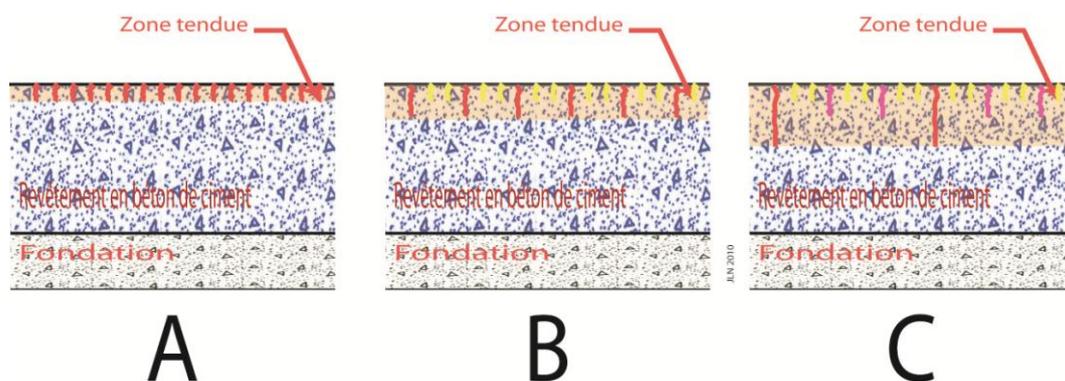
Origines des fissures dans le béton de ciment.
